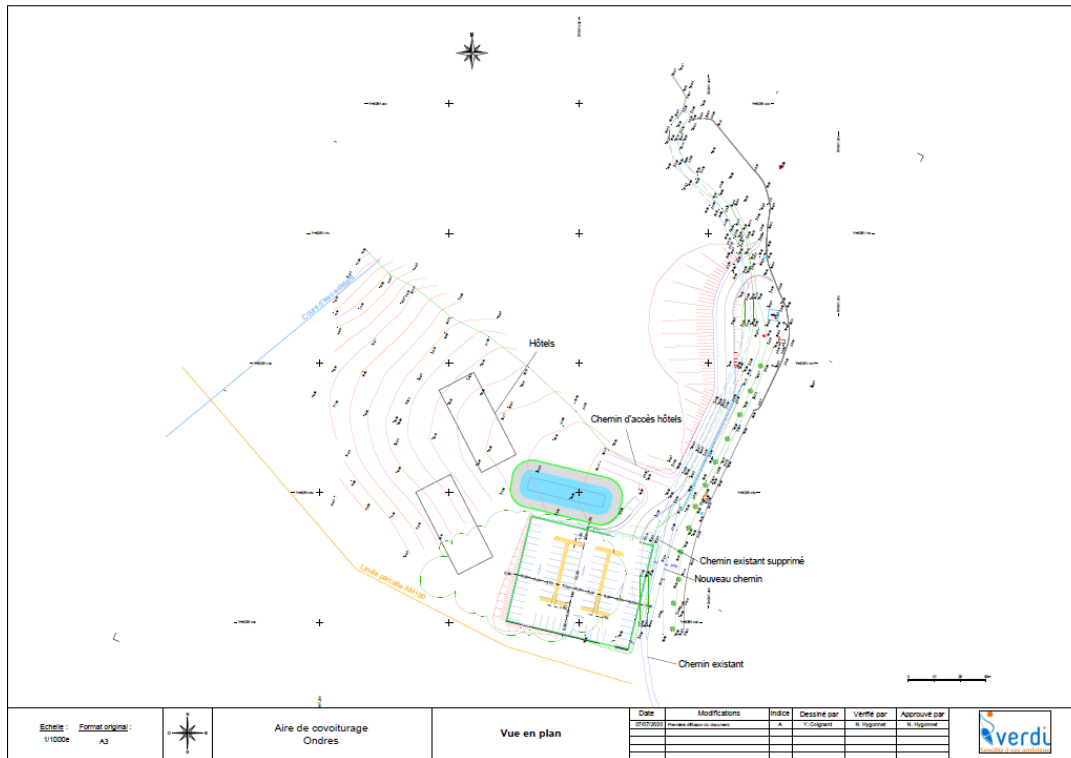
Vue en plan du projet d'aire de covoiturage de Ondres
